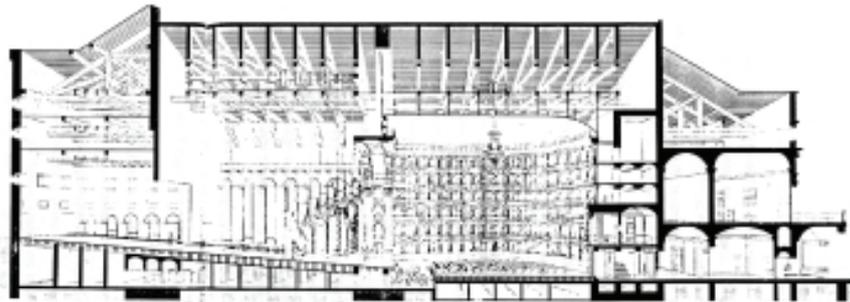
Corte de maquete depois da reforma. Torre da caixa cênica com 30 metros de altura, desde os elevadores de palco até o topo da caixa cênica. Teatro Alla Scala
